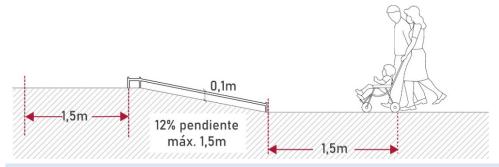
Rampas de longitud inferior a 1,5m requieren de protección lateral de mín. 0,1m.
